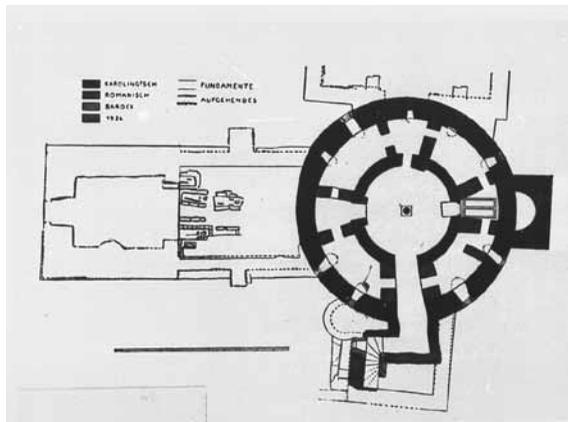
Grundriss der Krypta. Bildarchiv Marburg, 1938.
